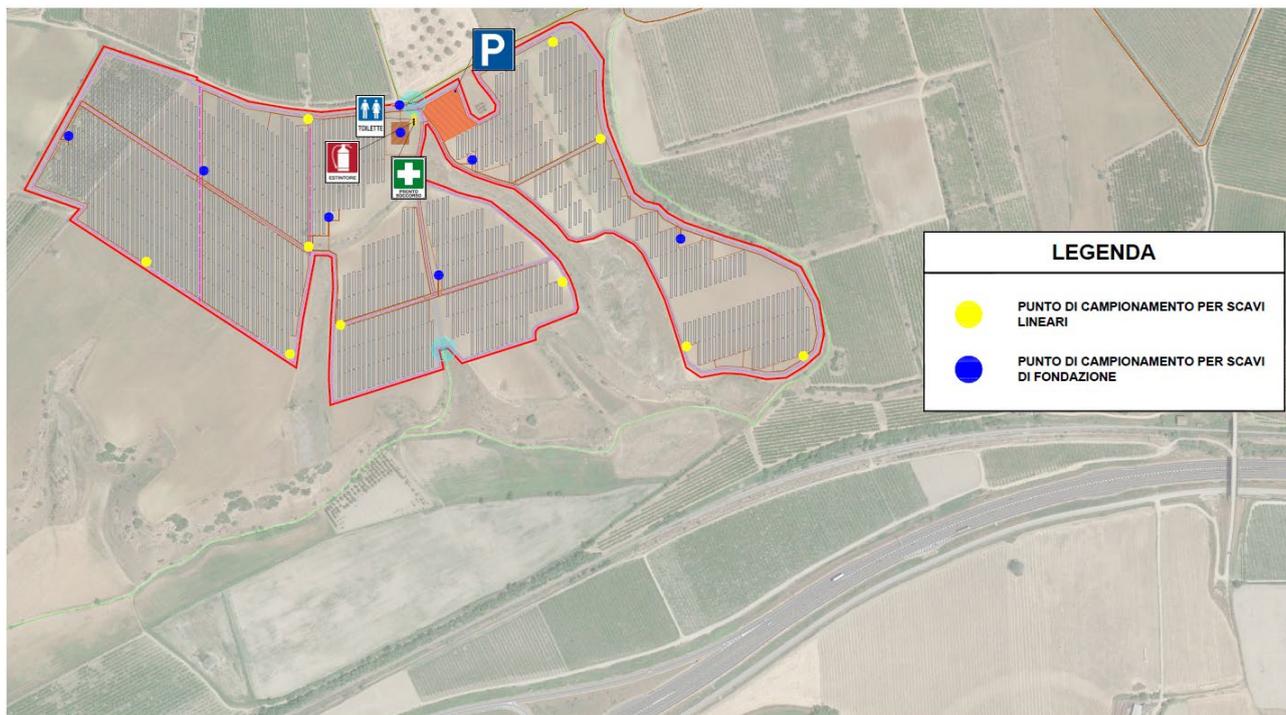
Layout impianto con piano di campionamento – Impianto area A
